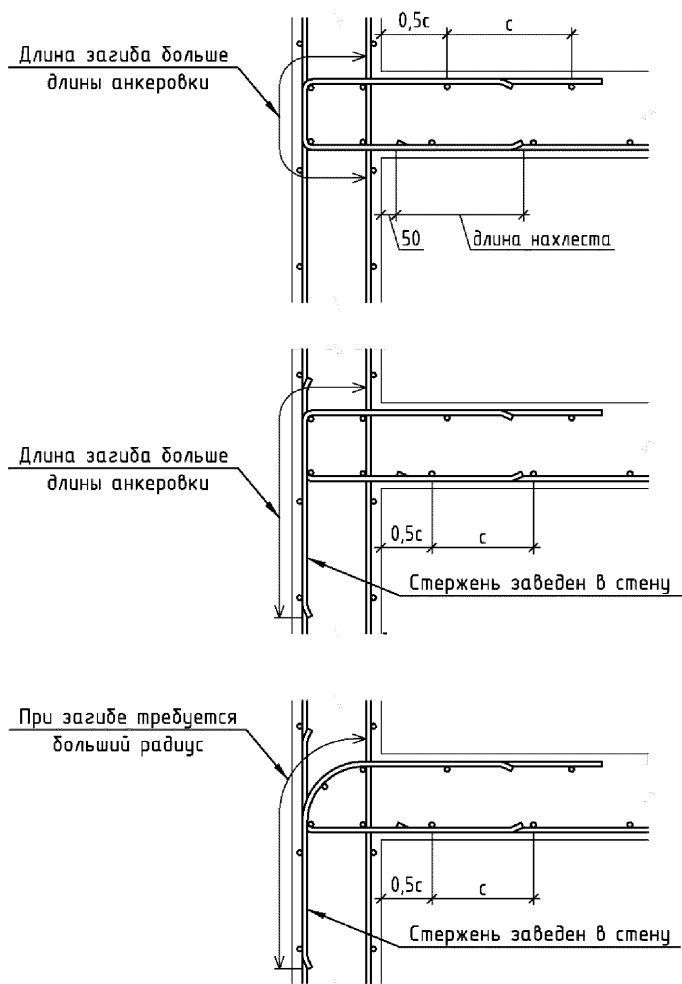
Типовой узел сопряжения перекрытия и стены
